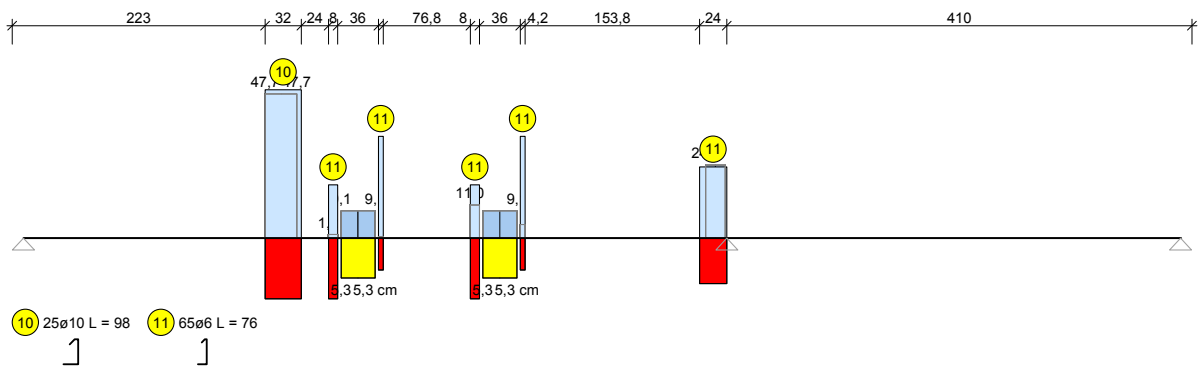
Konstruierte Querbewehrung. Maßstab 1 : 66,7, 1cm = 25cm²/m und 10cm Bügelabstand.
